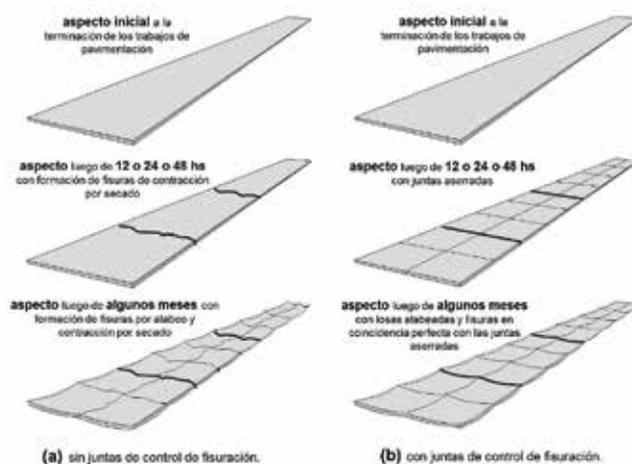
patrón de fisuración básica en pavimentos de hormigón (Becker, 2014)[1].
